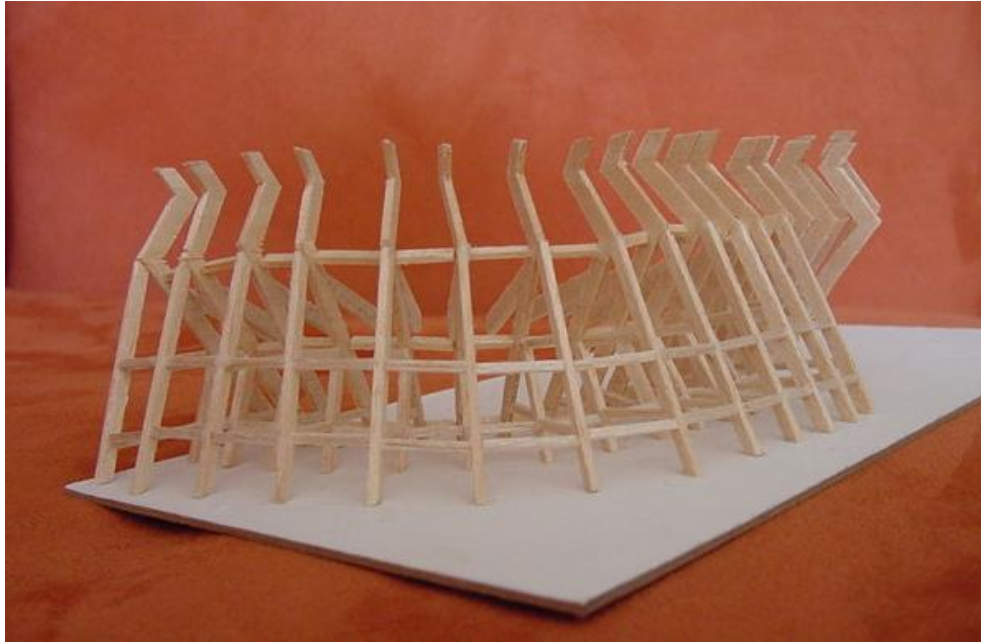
Estructura del estadio vista desde el exterior
